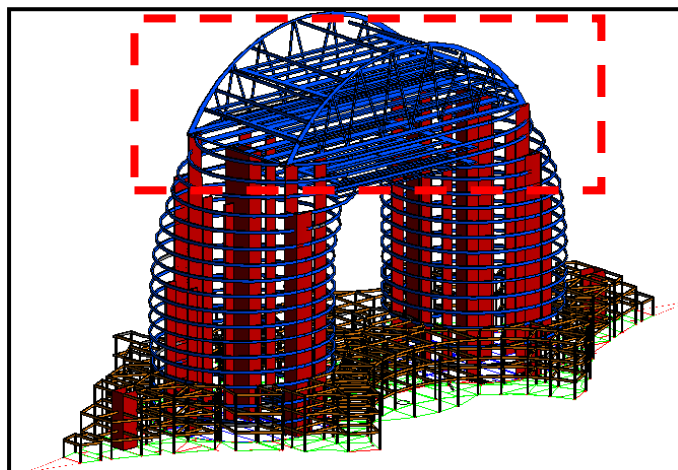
Détail de la poutre tridimensionnelle dans notre projet.
